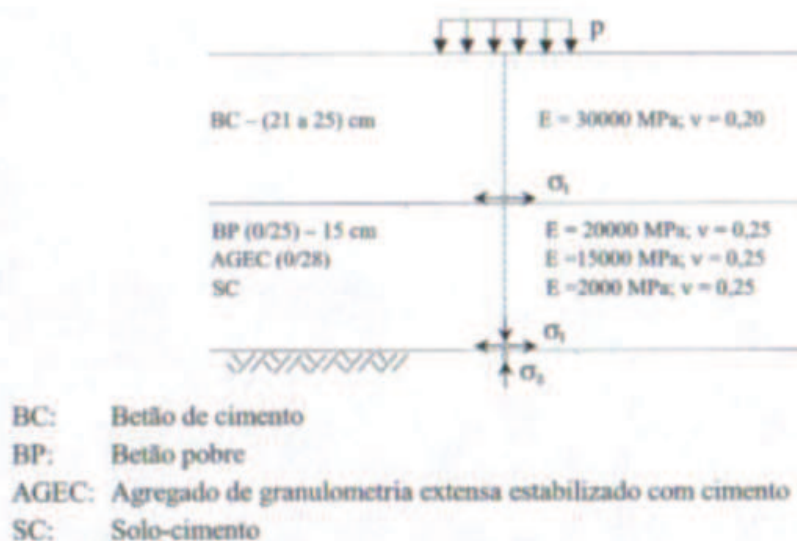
Constituição e comportamento de um pavimento rígido (Branco et al, 2006)
